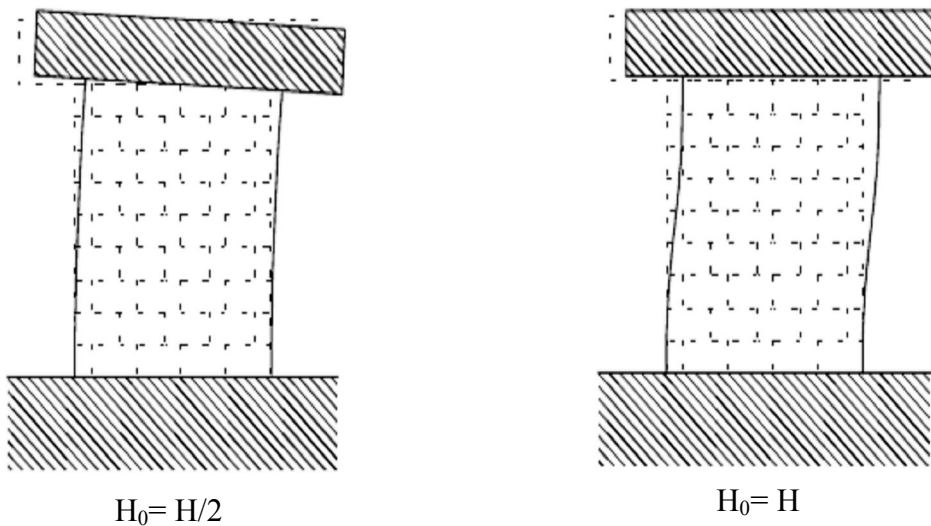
influence des conditions d'appui sur la hauteur déformable d'un panneau
